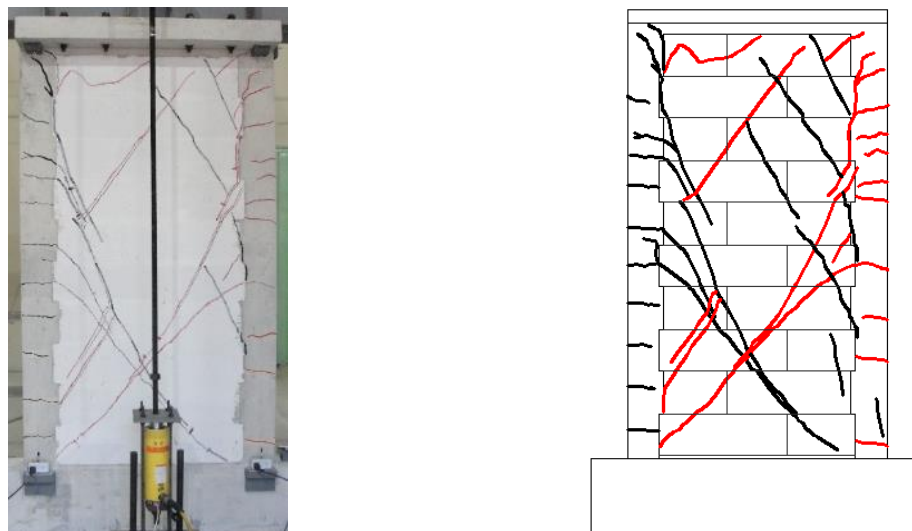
Grietas diagonales en la parte superior del muro Mc3
